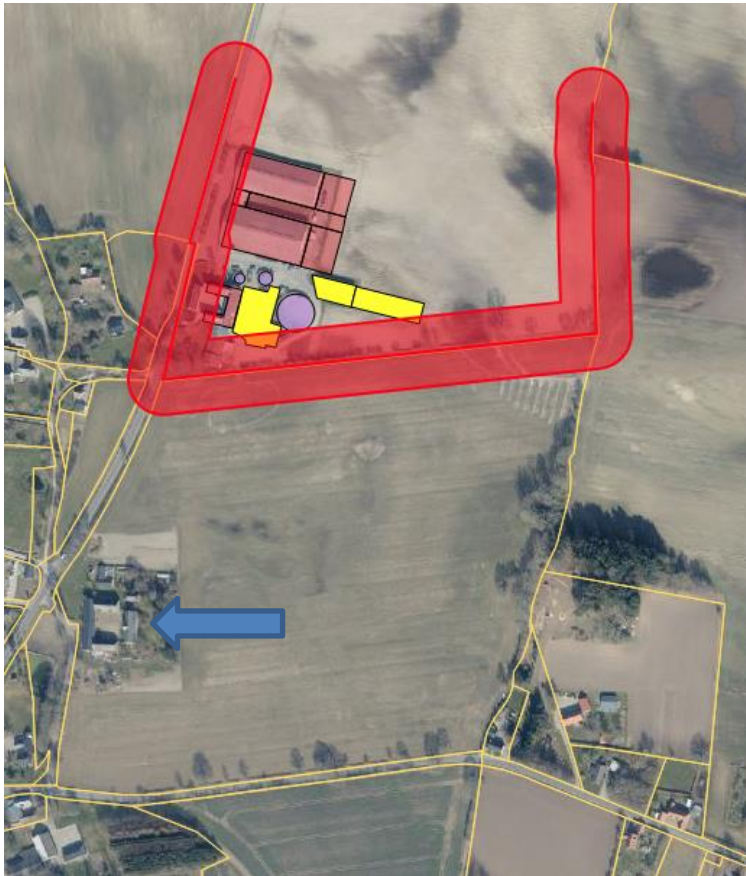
Skitse af bygningsmassen med 2 alternative placeringer af plansilo til ensilage.
